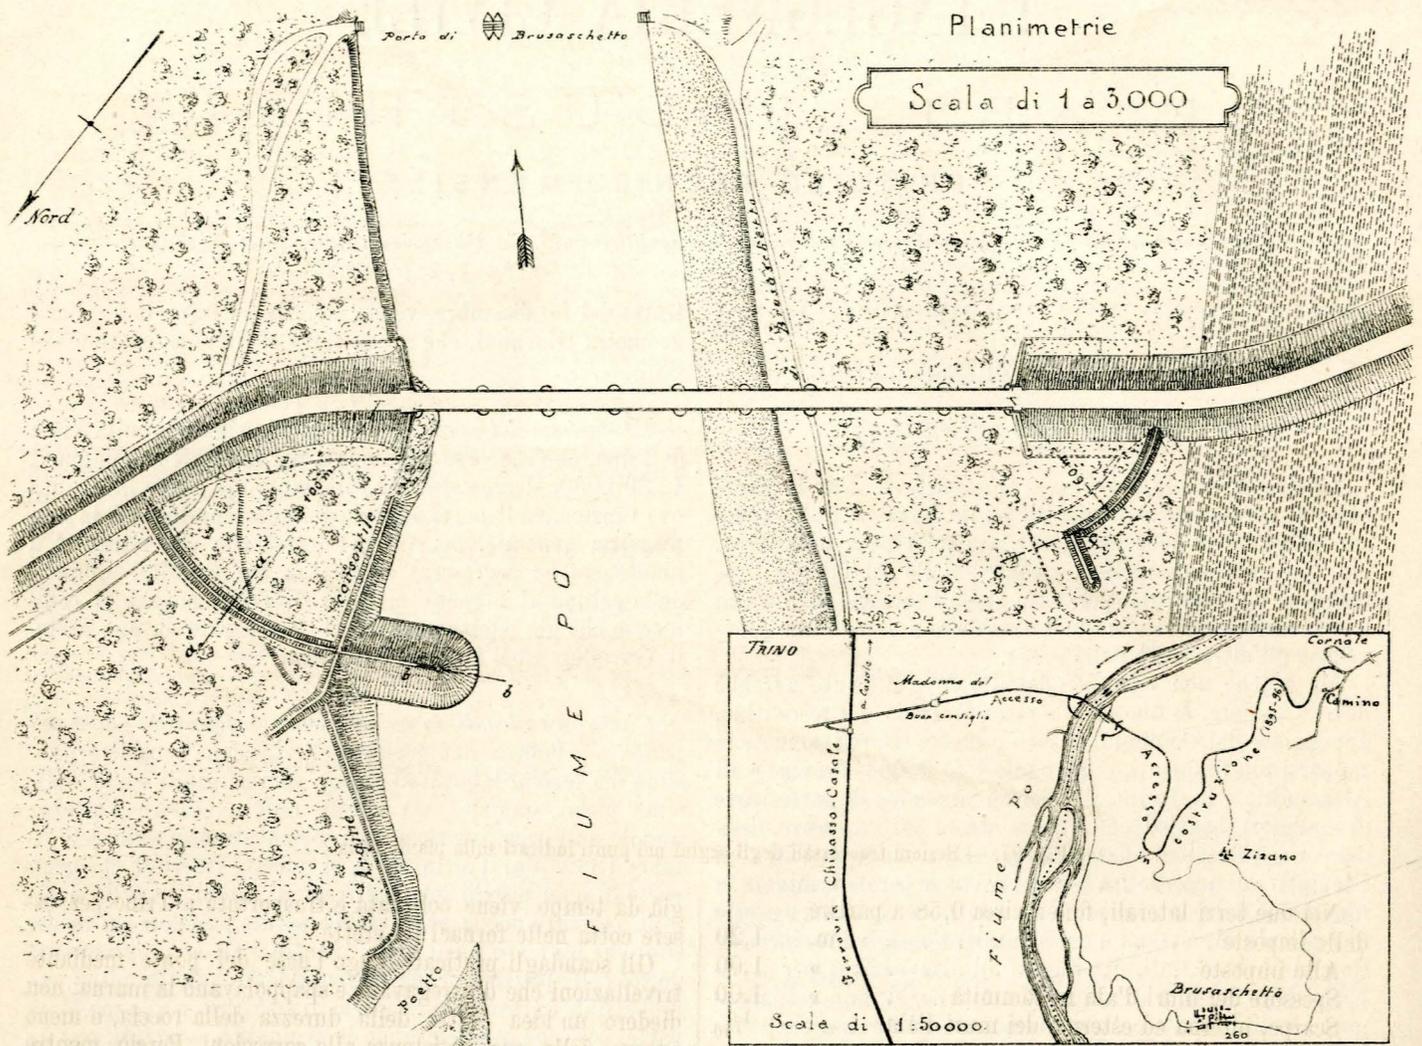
Planimetria generale e speciale del Ponte sul Po presso Trino.
